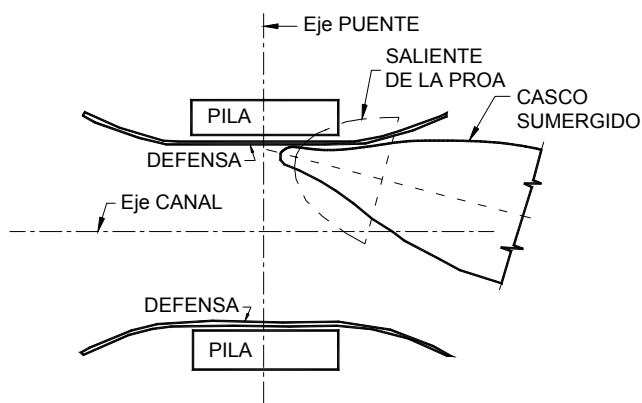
Vista en planta de una saliente de la proa de un buque impactando contra una pila
